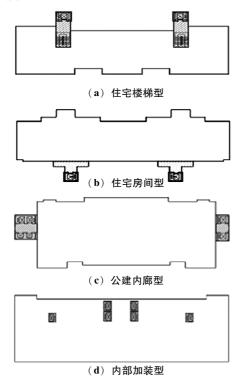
电梯加装方位类型 Fig. 1 Elevator installation direction type
